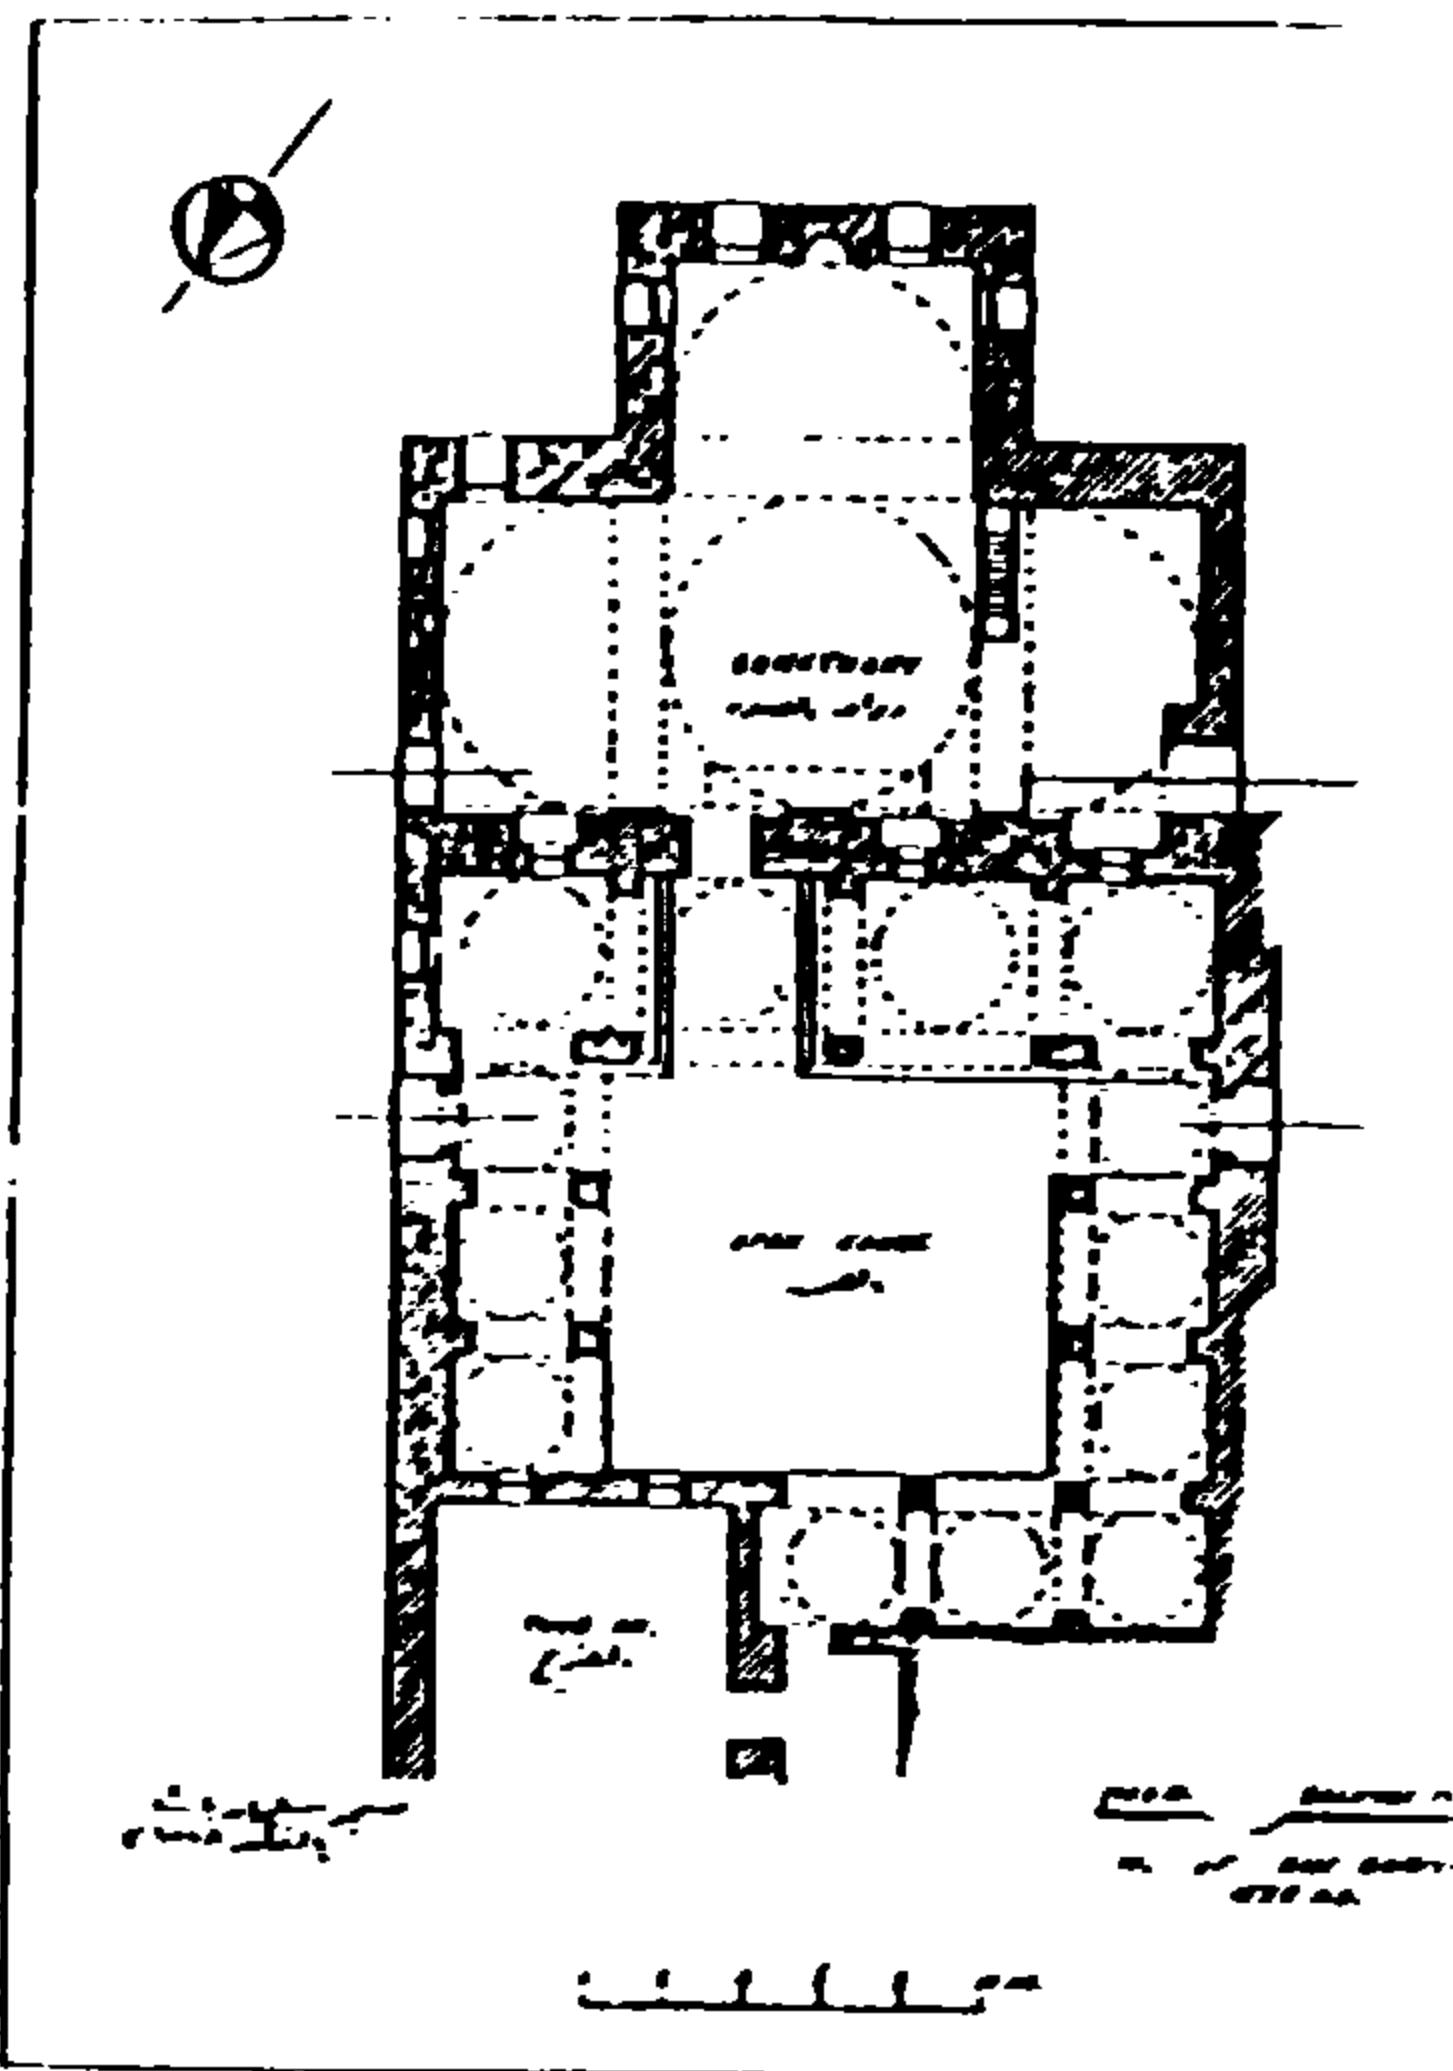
المسقط الأفقي لجامع يوسف الحسين
